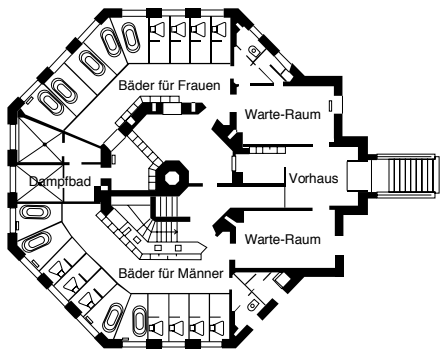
Tröpferbad Grundriss von 1954
